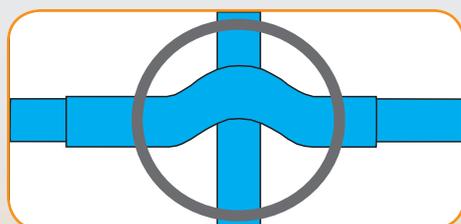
Прокладка труб с перекрещиванием проводится с помощью специальной фасонной части, предназначенной для этой цели.
